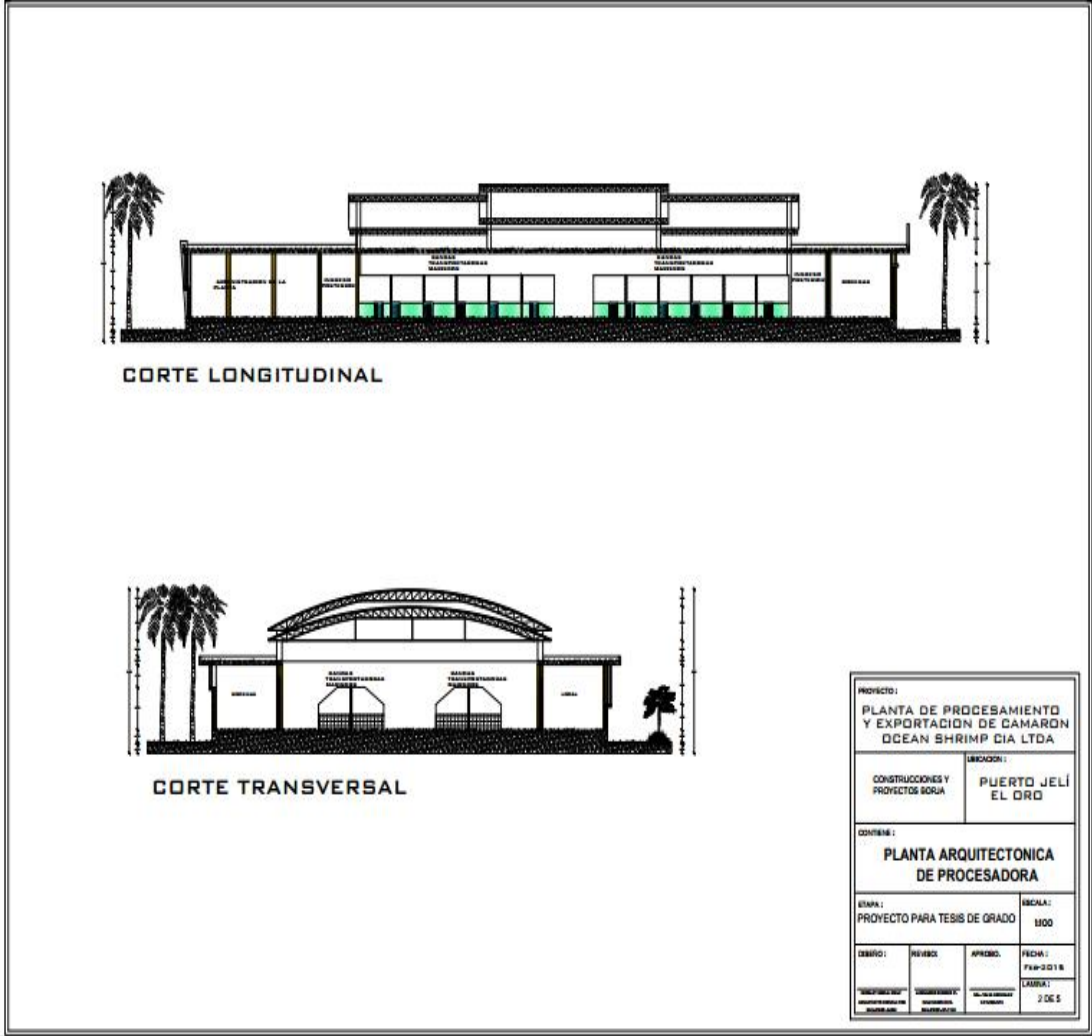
PLANTA ARQUITECTÓNICA
